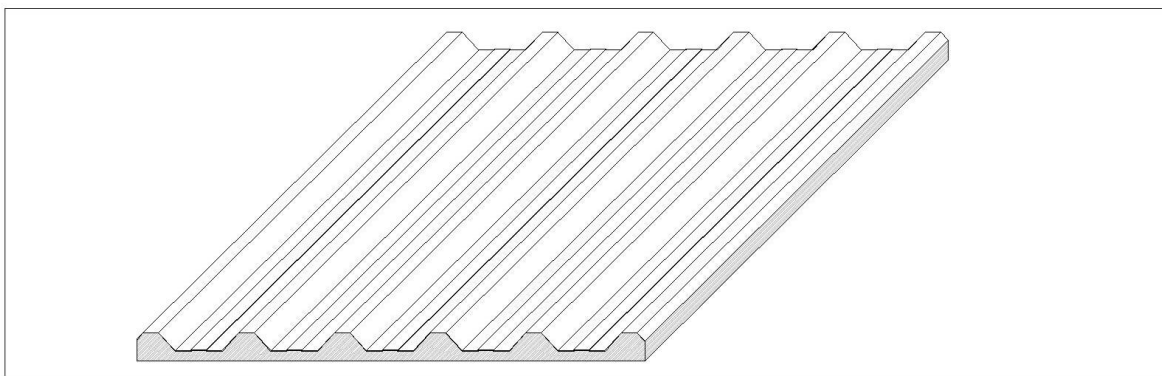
Telhas de aço trapezoidal, tipo sanduíche termoacústico - TR40
